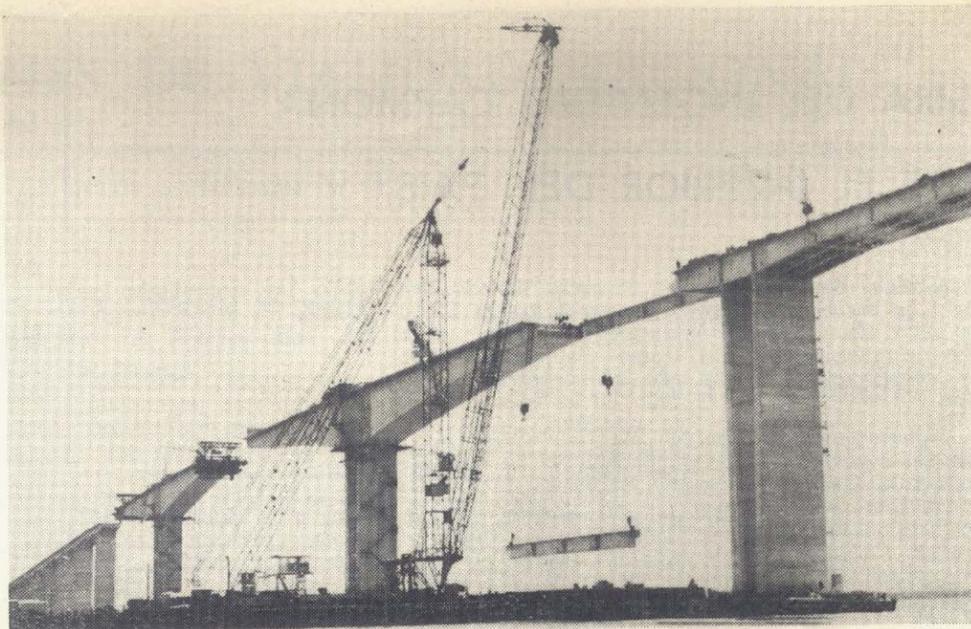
Etapa constructiva. En primer plano montaje de viga prefabricada, entre la ménsula cajón de pila principal Nº 10 y doble ménsula de pila secundaria Nº 9. En segundo plano operando los carros-grúas de hormigonado de dovelas en las ménsulas de pila principal Nº 11.
